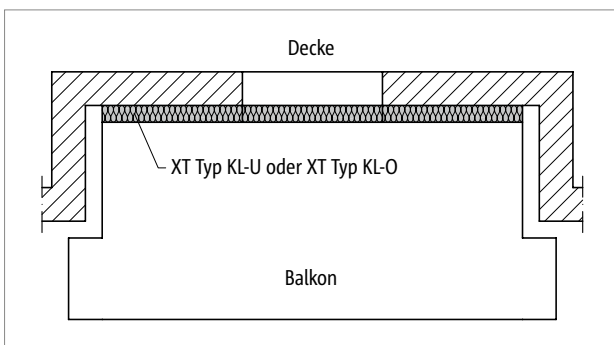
Schöck Isokorb® XT Typ KL-U/KL-O: Balkon bei Fassadenversprung
